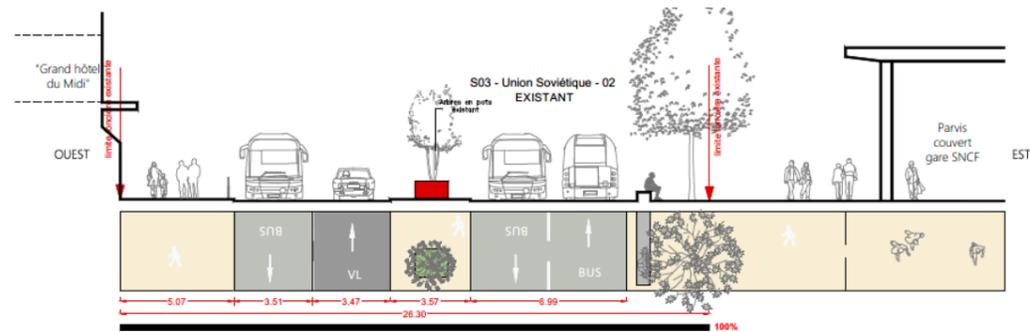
Profil existant sur le boulevard de l'Union Soviétique au droit de la gare
